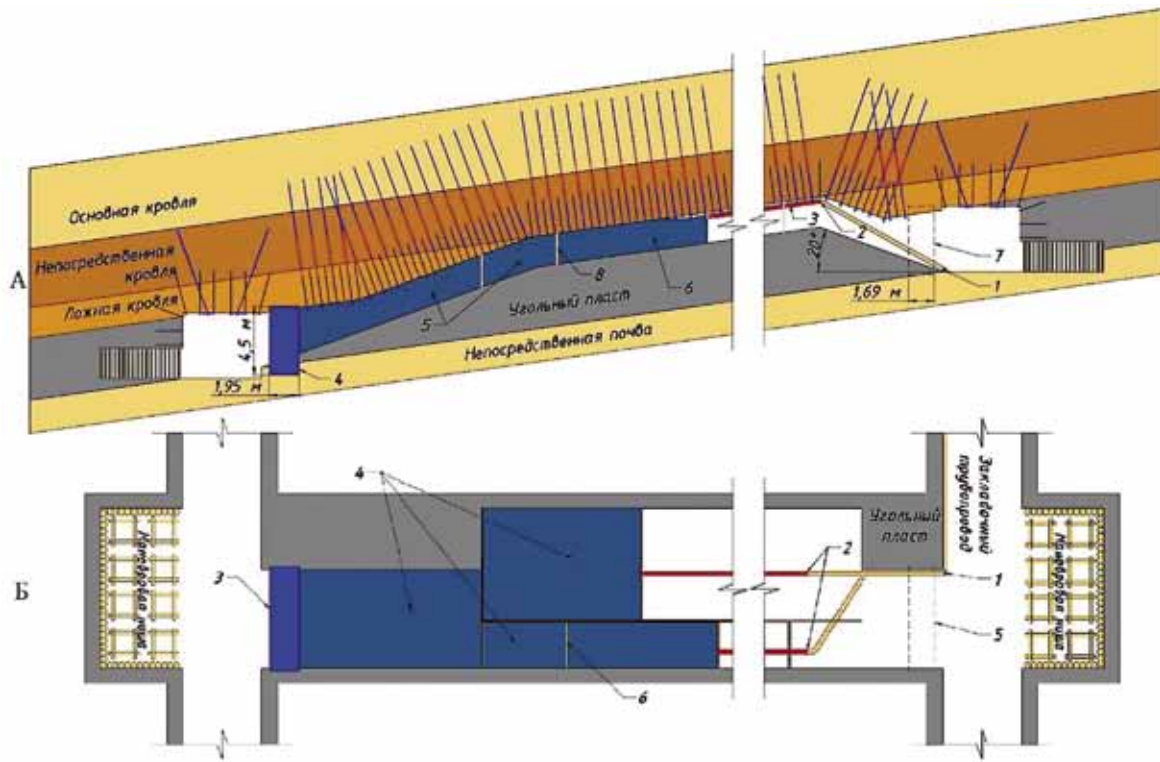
Схема предлагаемого способа возведения искусственного перекрытия: А – продольный разрез; Б – вид сверху; 1 – клапан аварийного сброса смеси; 2 – места соединения металлического и полиэтиленового трубопроводов; 3 – изолирующая перемычка; 4 – блоки закладочного массива; 5 – место возведения изолирующей перемычки; 6 – межблоковая опалубка
